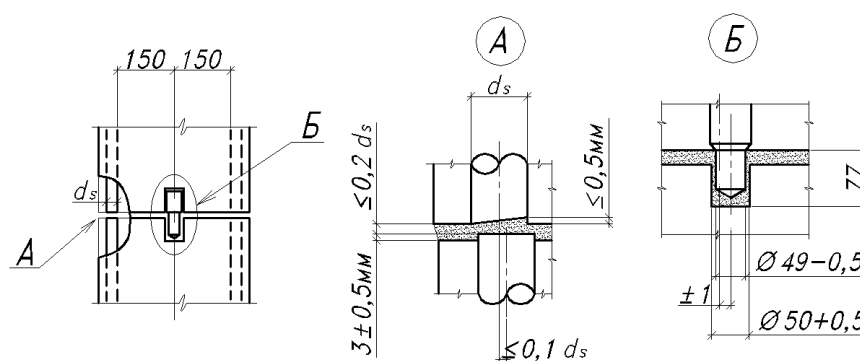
Схема плоского бесварочного стыка и допуски на изготовление и монтаж
